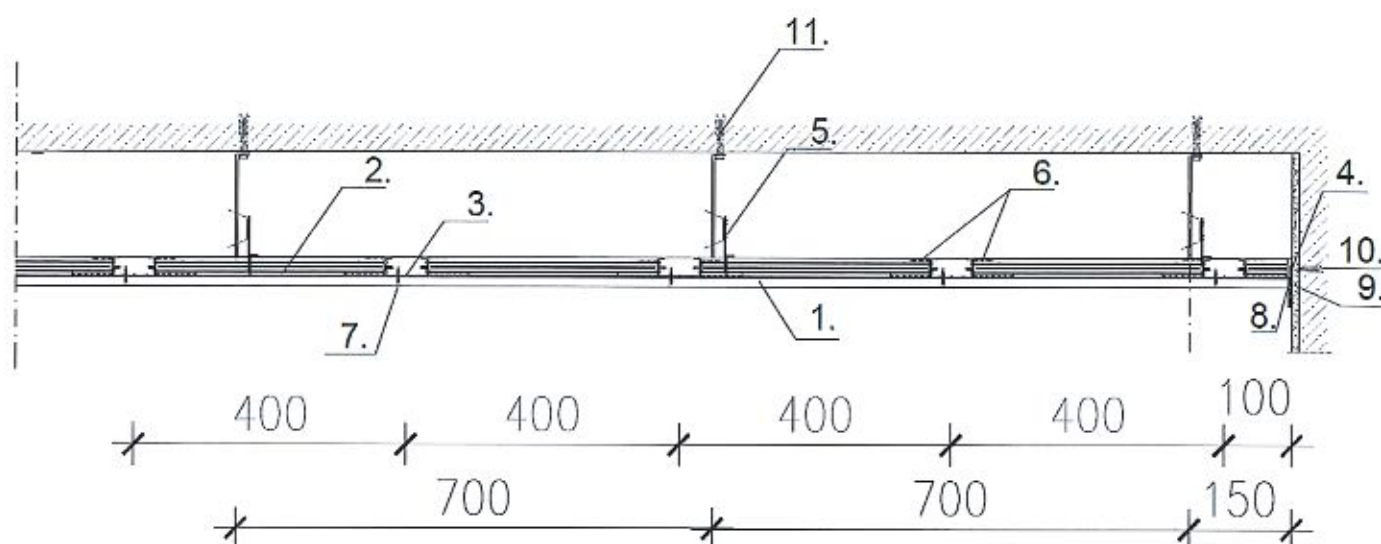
Przekroje poprzeczne i podłużne sufitu podwieszanego – konstrukcja krzyżowa dwupoziomowa
